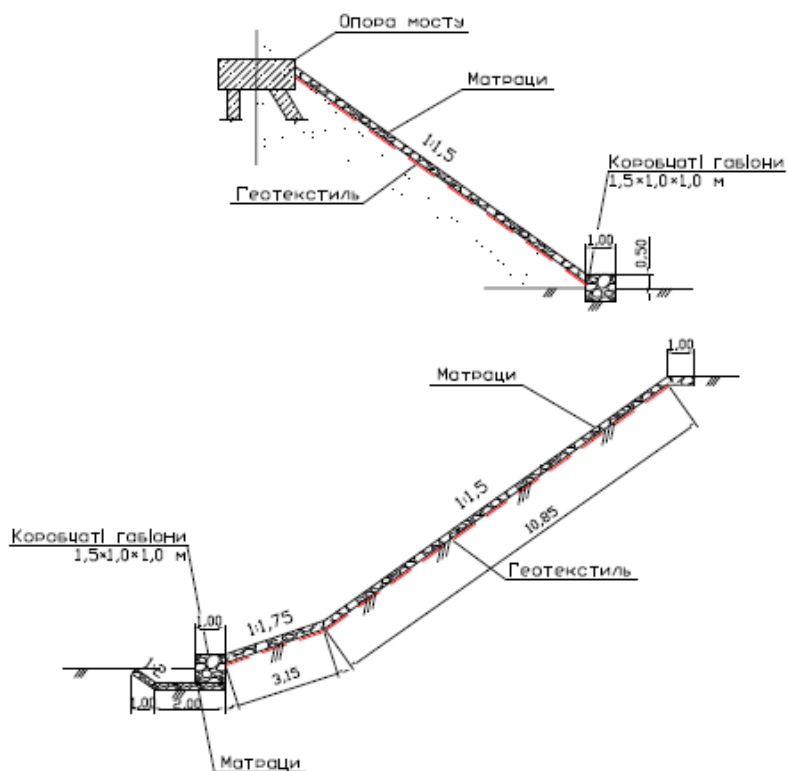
Схеми укріплення габіонними конструкціями невідтоплених укосів:
